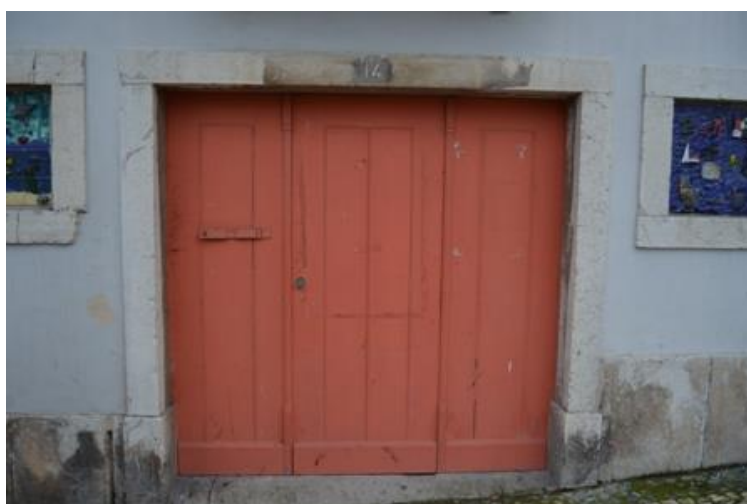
Detalhe da moldura de cantaria do vão - porta do piso térreo da fachada Norte. Foto: Museu Municipal.
